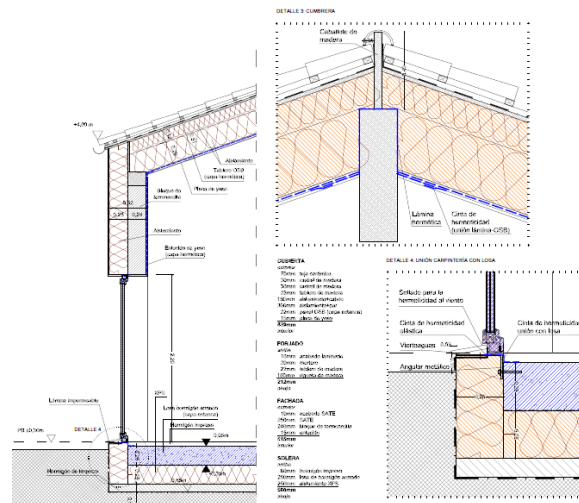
Sección constructiva de la Casa Taller Laboratorio Passivhaus.
